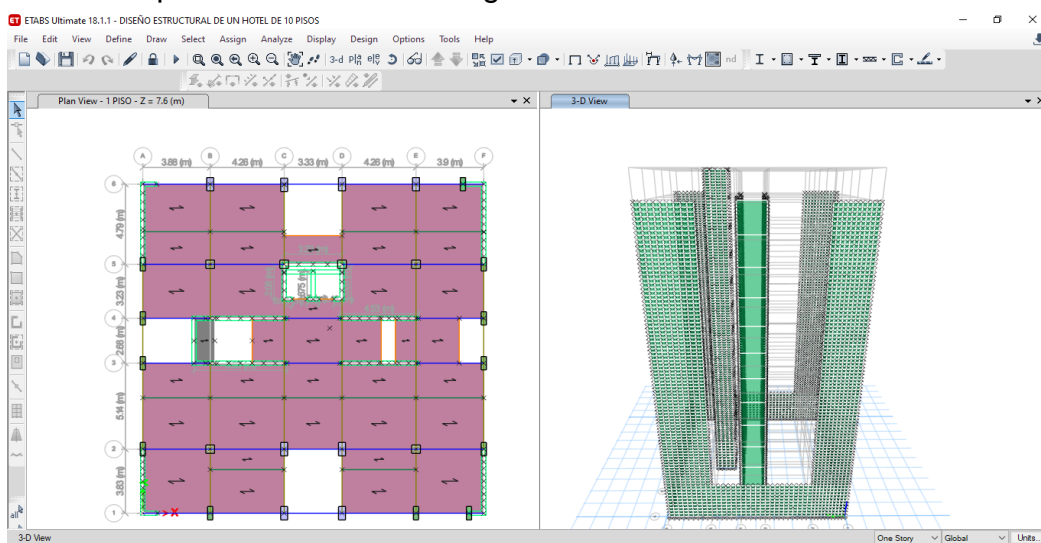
Izquierda - vista en planta del piso N° 1 / Derecha - vista 3D de las placas en toda la estructura.
